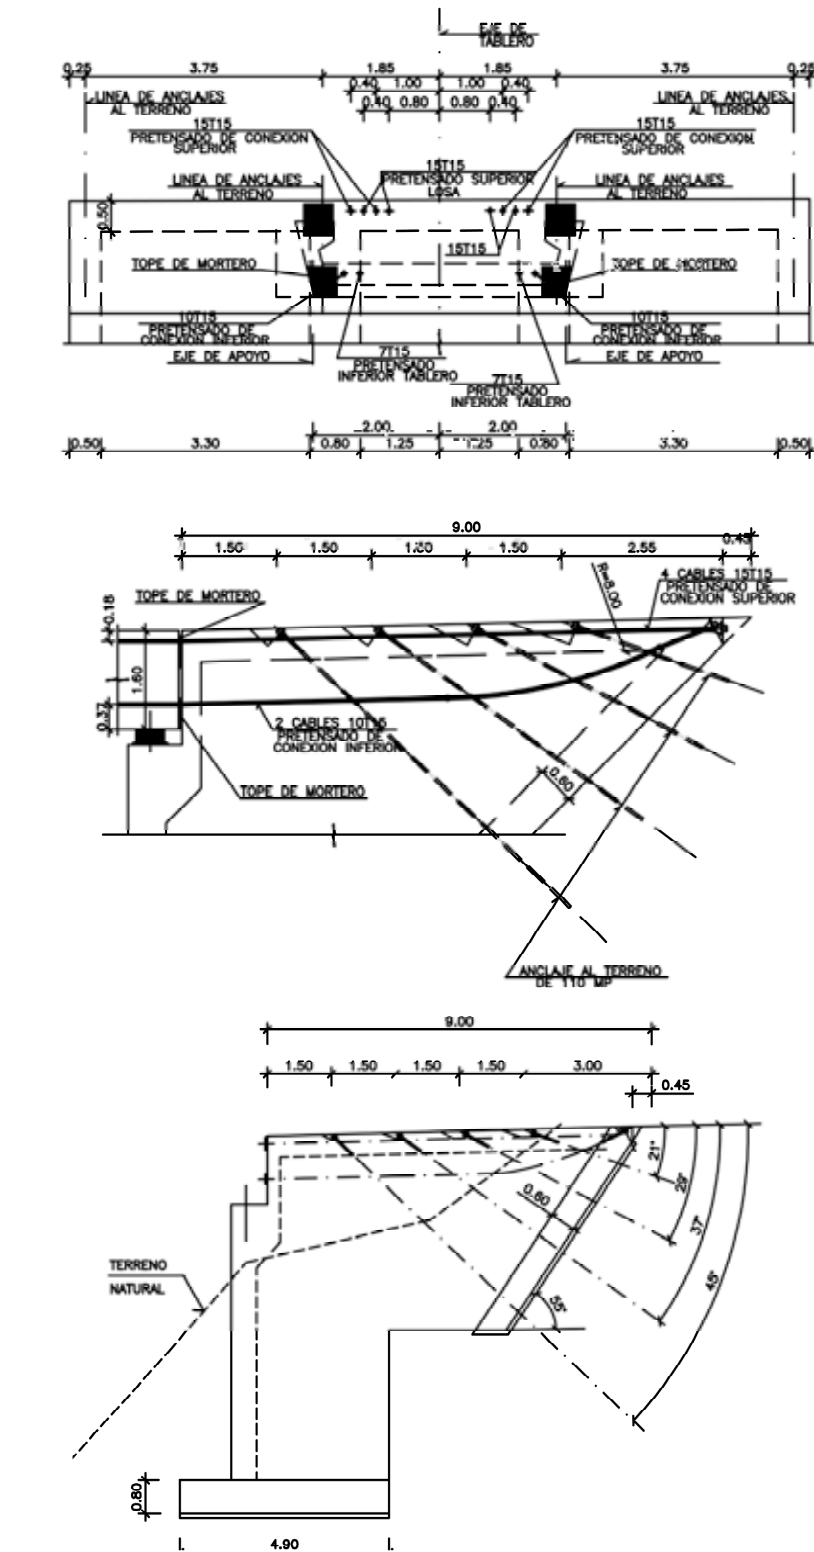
Alzado de estribo y detalles de disposición de anclajes al terreno y conexión temporal del tablero al estribo.
